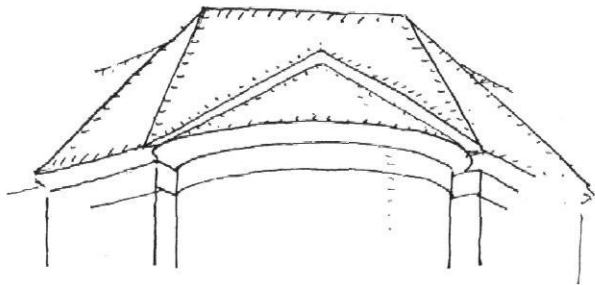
| Dachlösung an der Ecke des Künstlerhauses
